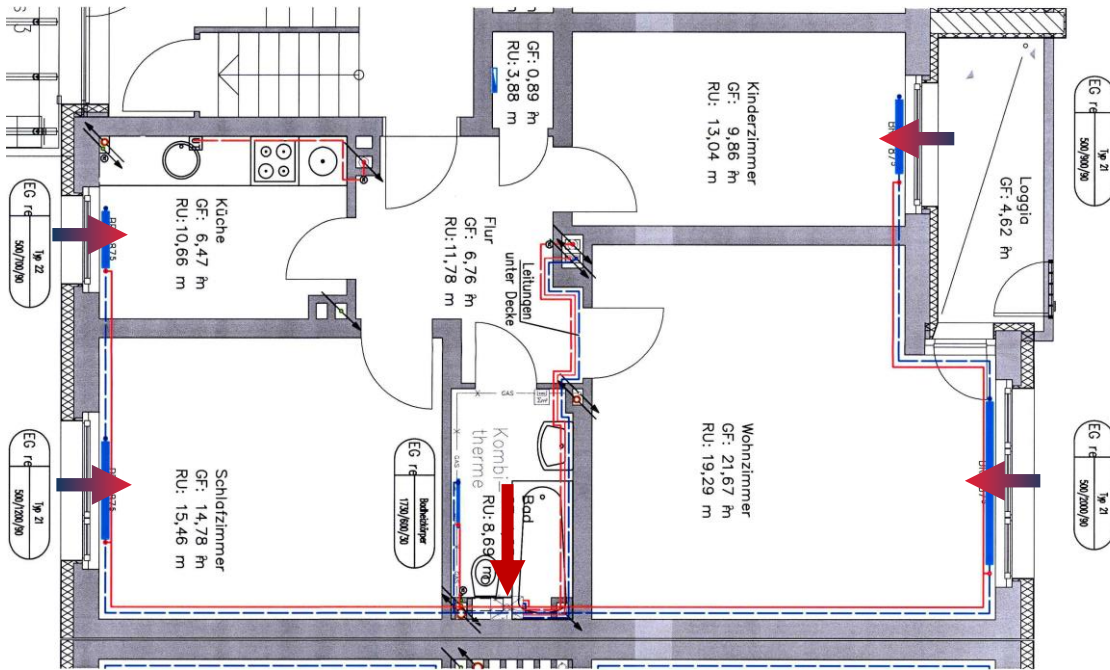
Grundrissausschnitt EG mit fensterlosem Bad eines Mehrfamilienhauses mit Entlüftungssystem und ALD, modifizierte Abbildung Firma Grundlach-Wohnungsunternehmen.
